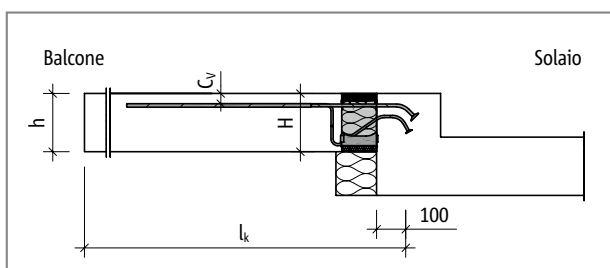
Schöck Isokorb® XT tipo KL-O: schema statico
